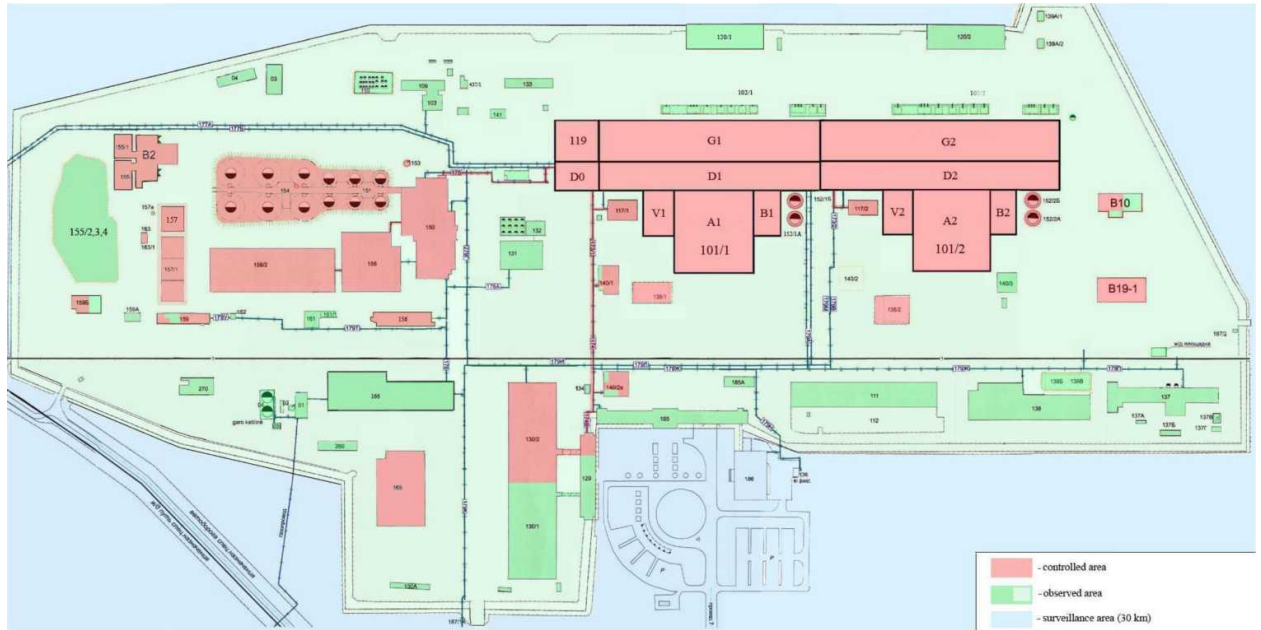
Схема расположения зданий на площадке ИАЭС. Здания, отнесённые к контролируемой зоне, выделены красным цветом. Остальные здания и территория площадки отнесены к зоне наблюдения (выделены зелёным цветом)
